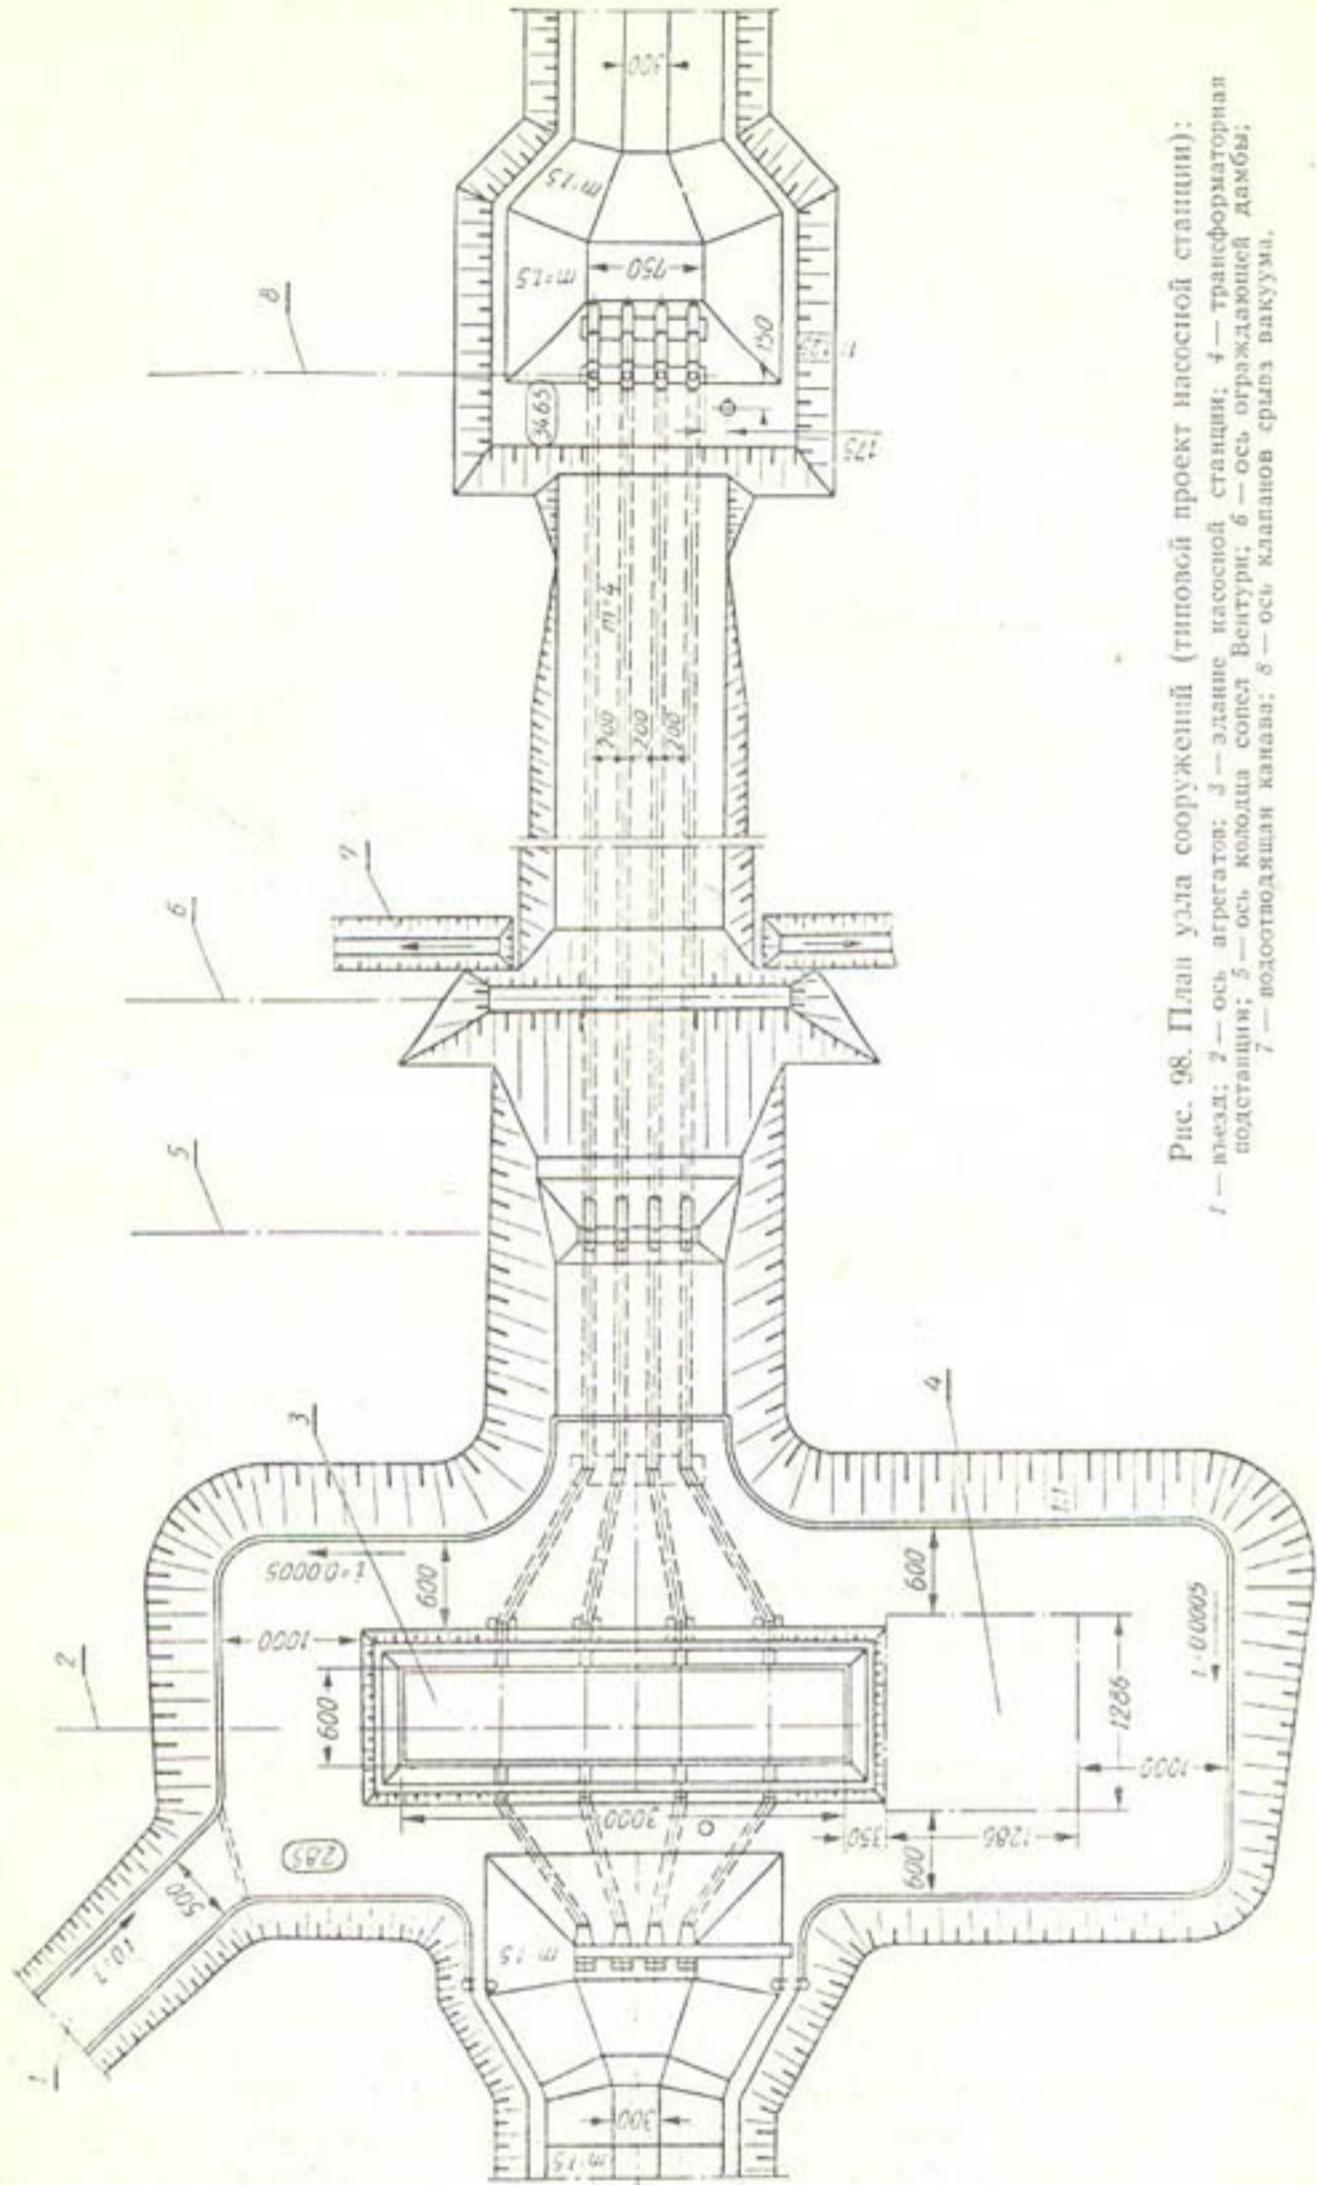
План узла сооружений (типовой проект насосной станции):
